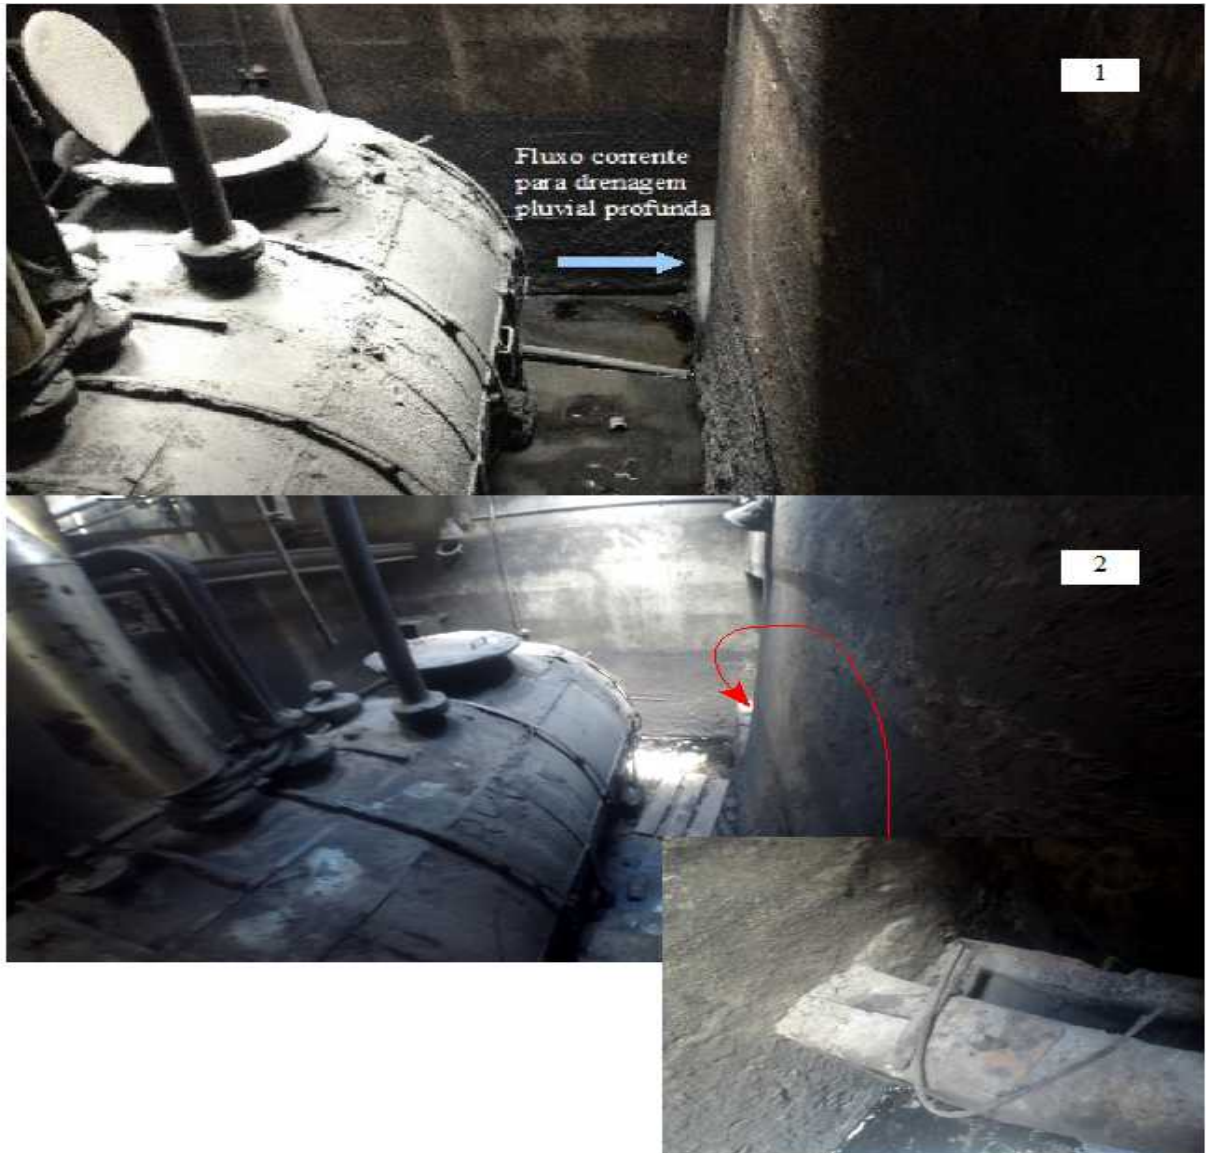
Construção de barreira para interrupção de fluxo de água contaminada proveniente da caixa de contenção que escoava para drenagem pluvial, nas instalações de tanque subterrâneo localizado próximo ao sistema de bombeamento da fase B. Foto 1 de set/16 e foto 2 de jan/17. Destaque para a barreira construída.
